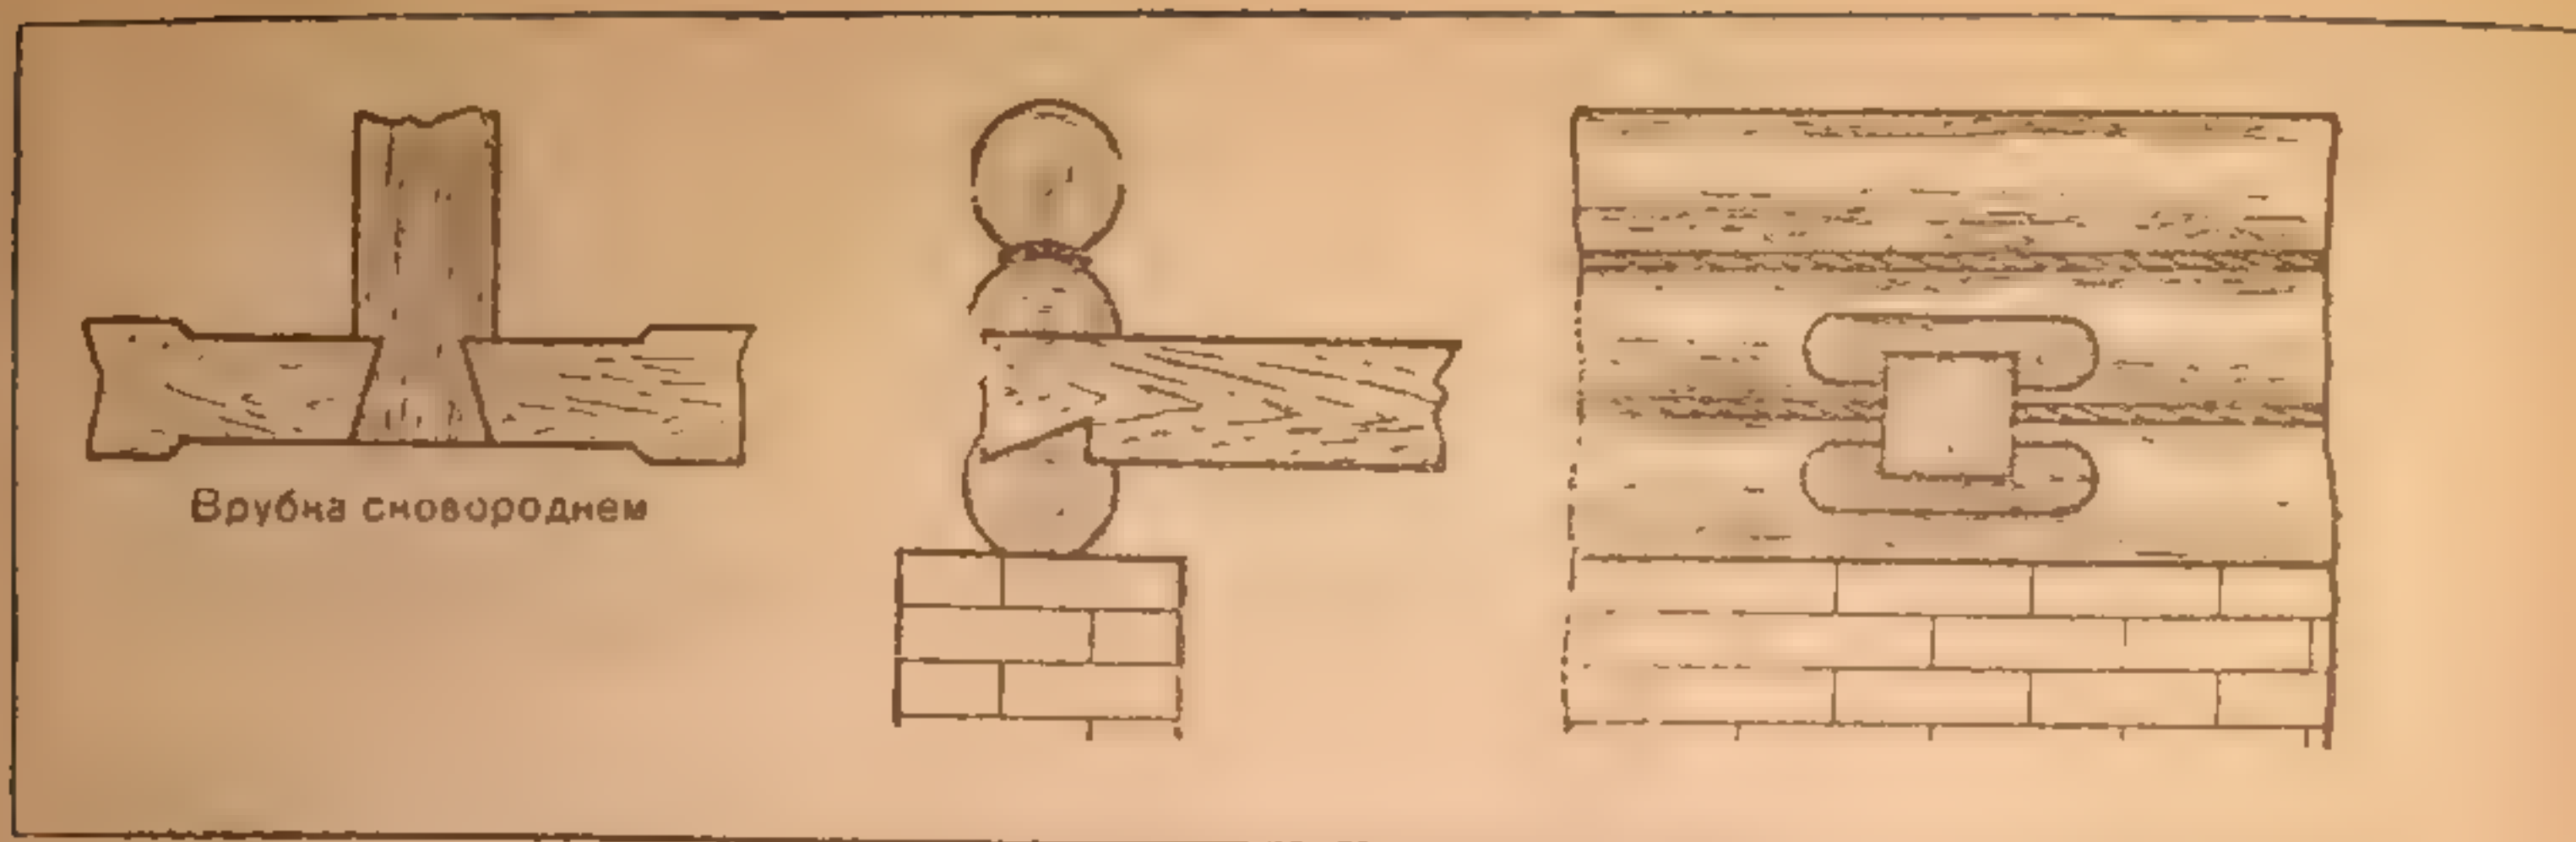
Врубка балок в деревянные рубленые стены, укладываемые на сплошном цоколе
